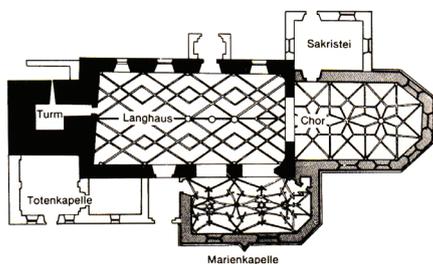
| Grundriss Pfarrkirche bis 1978, Marktgemeinde St. Martin i.M. 2005, 72
